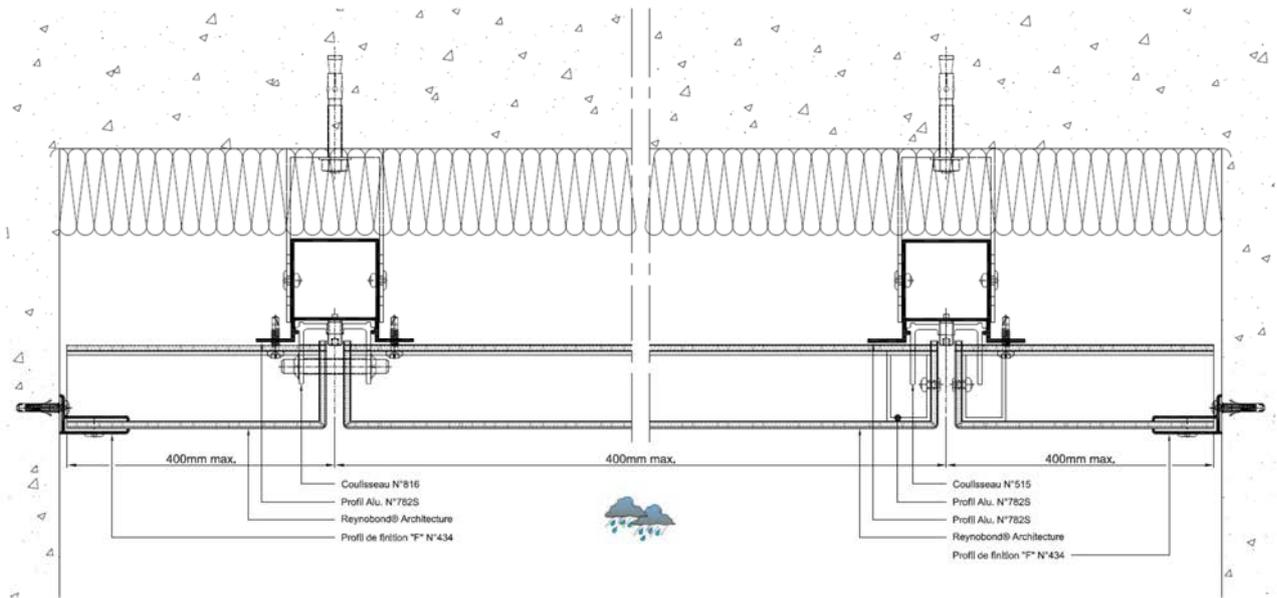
Pose en sous-face de dalle - KU50VA & NVA - Raccord Latéral
